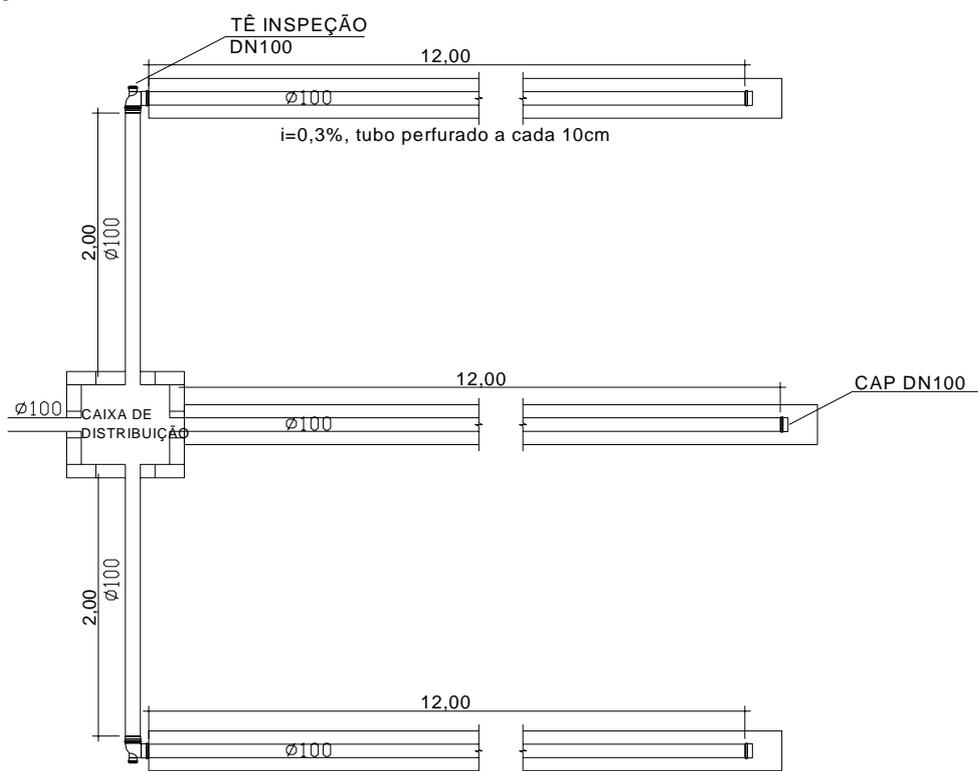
Esquema de implantação das valas de infiltração. *Dimensões em metros (m).
